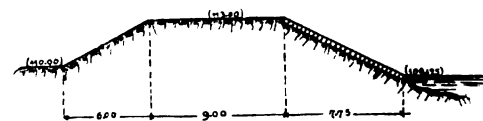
Sezione secondo a b della fig. 1 (Scala 1:500).
